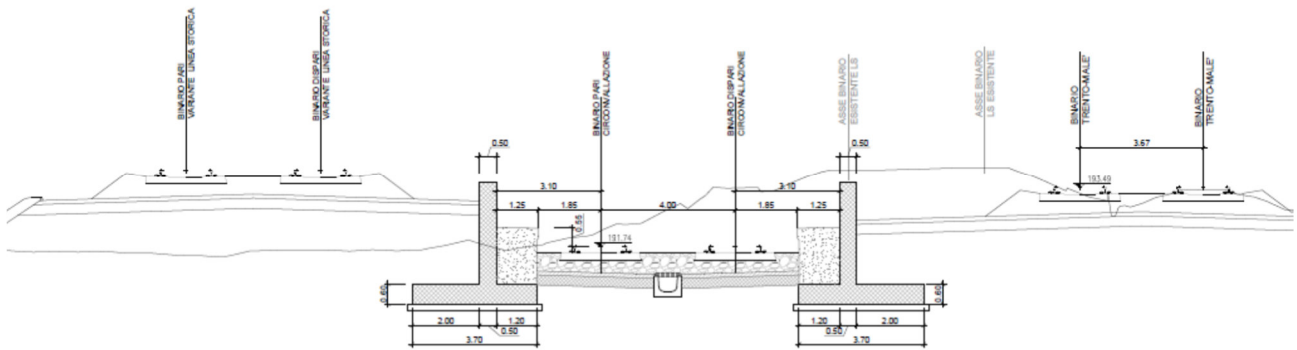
TR04. Sezione trasversale tra muri in c.a.
